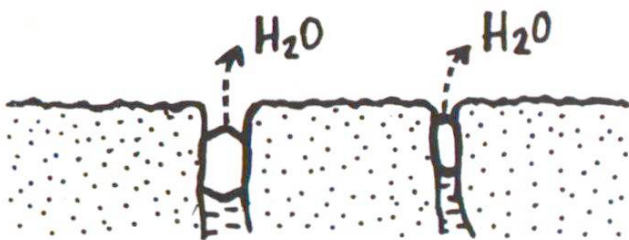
Par temps sec, l'eau des capillaires s'évapore déjà avant de sortir du béton. La chaux qui cristallise alors en dessous de la surface obture l'issue des capillaires. C'est la raison pour laquelle un béton ne produit plus d'efflorescences de chaux après quelques semaines d'exposition à l'air.
